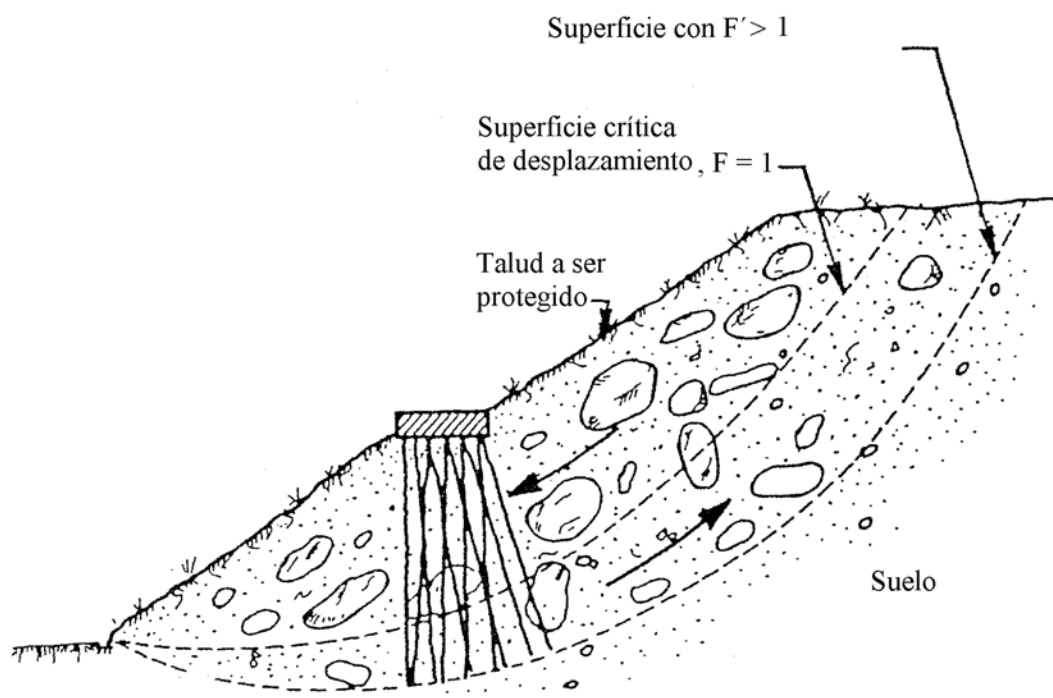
Estructura de pilotes reticulados en suelos sueltos (Lizzi, 1978).
